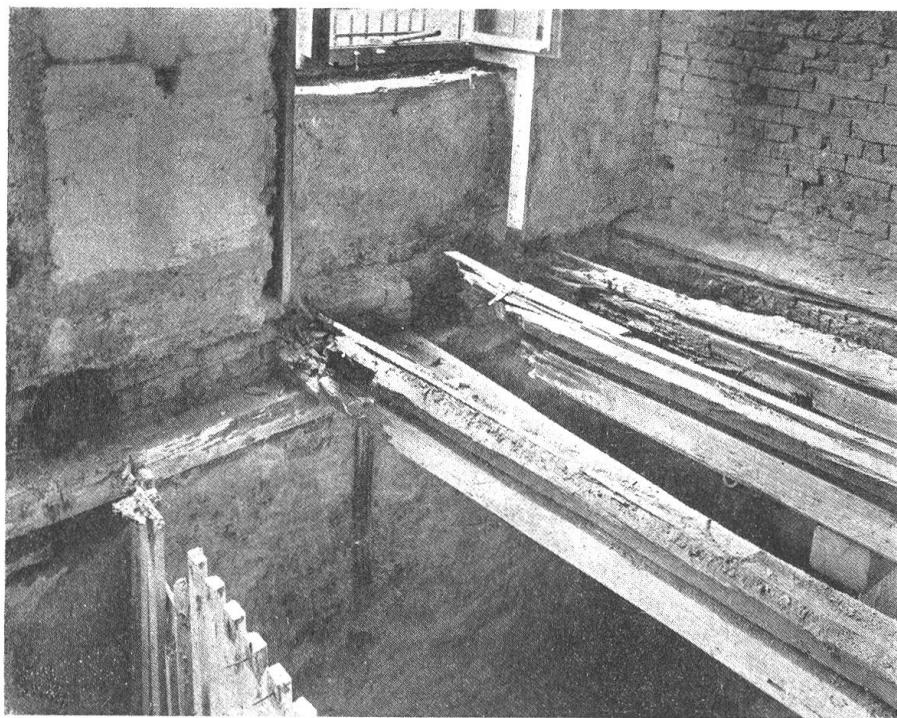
Vom Hausschwamm zer-mürbtes Balkenwerk einer eingestürzten Decke
